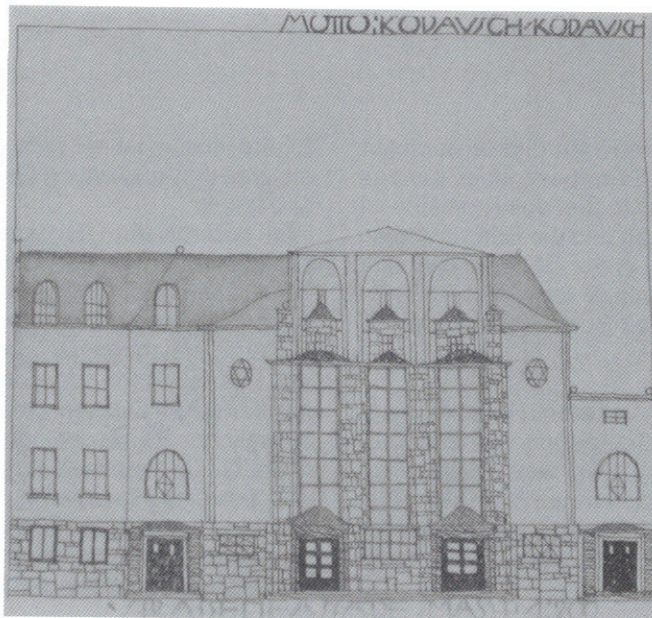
Ernst Lichtblau: Entwurf für den ersten Wettbewerb, Fassade.
